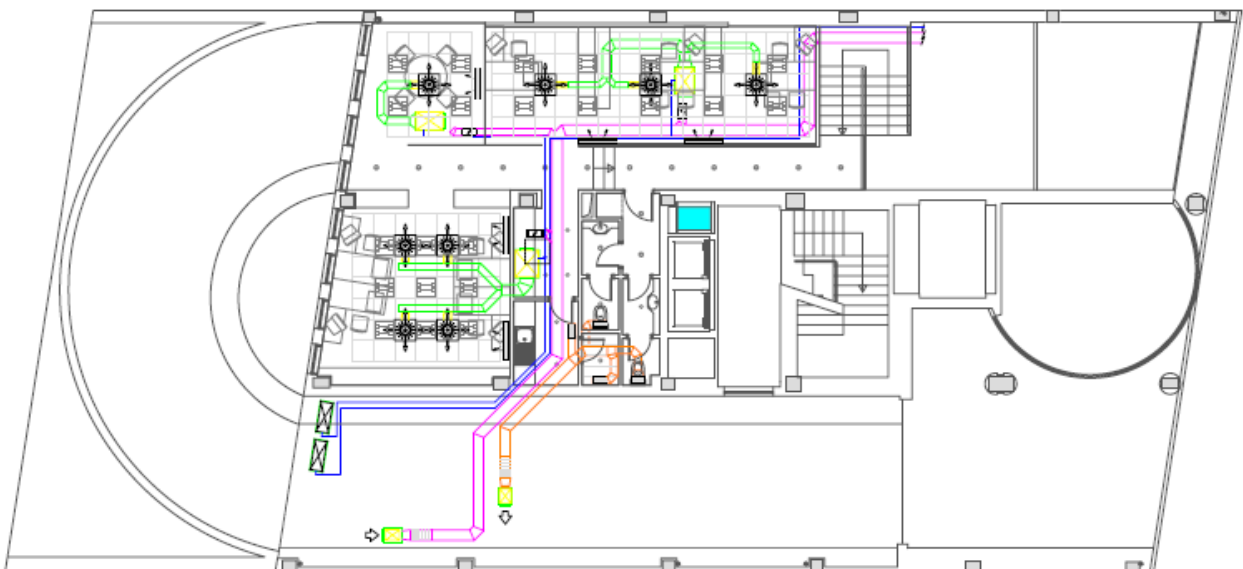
Plano Planta Entreplanta de Oficinas Retailing One
